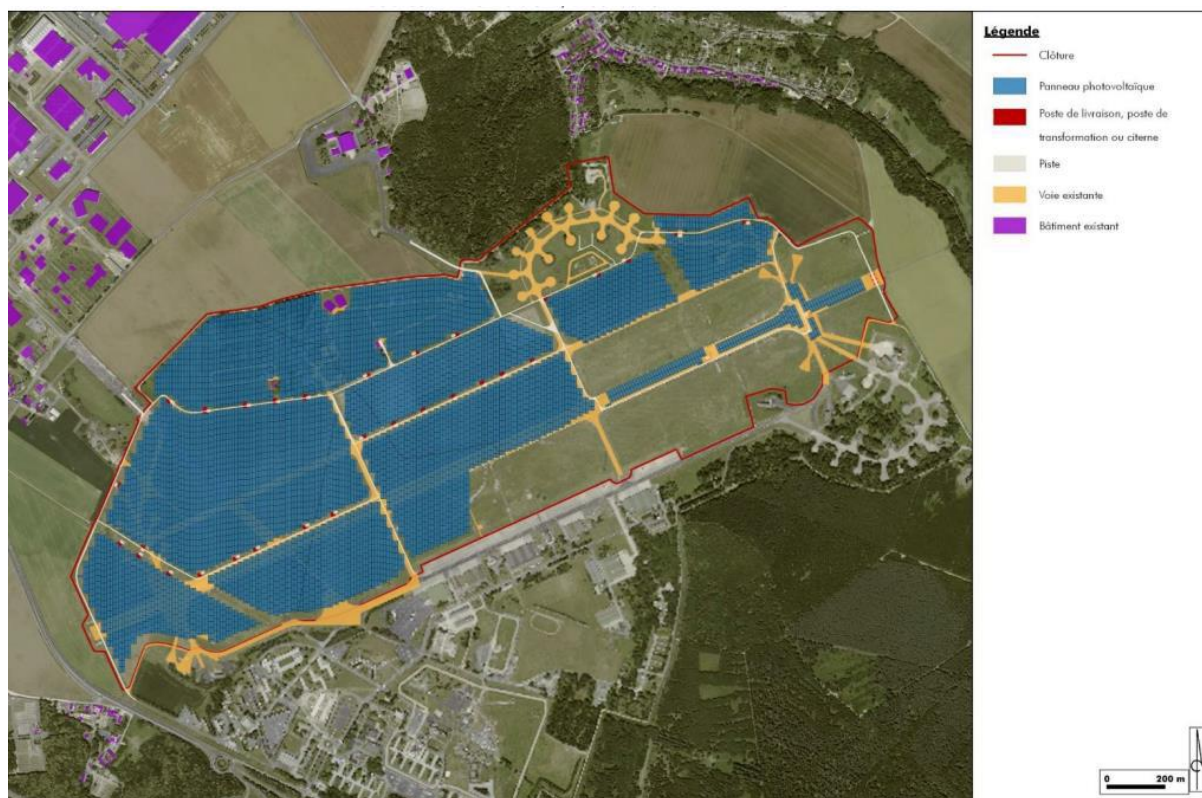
Variante n°3 du plan d'implantation (source : Photosol, Réalisation ARTIFEX 2021)
